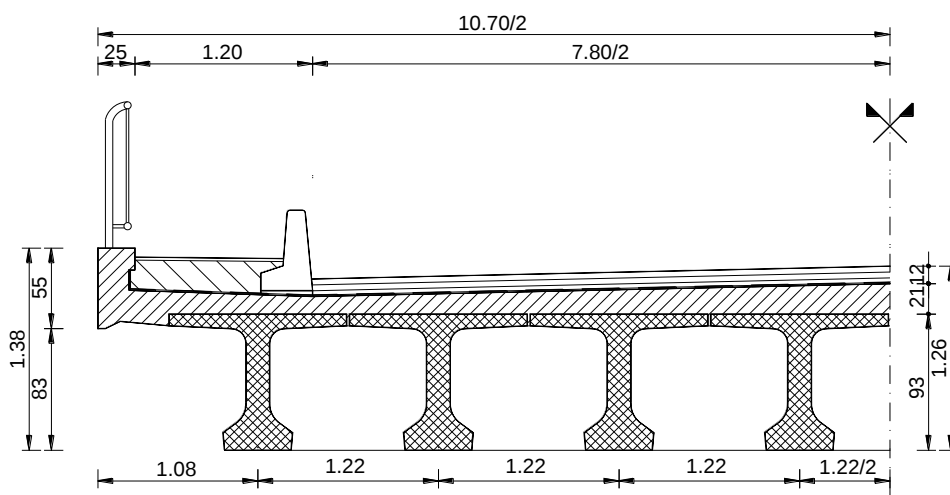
Secțiune transversală – Tablier pe grinzi prefabricate din beton precomprimat cu armături aderente
